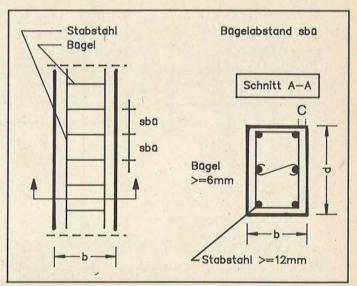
Aufbau einer fertigen Stahlbetonstütze
